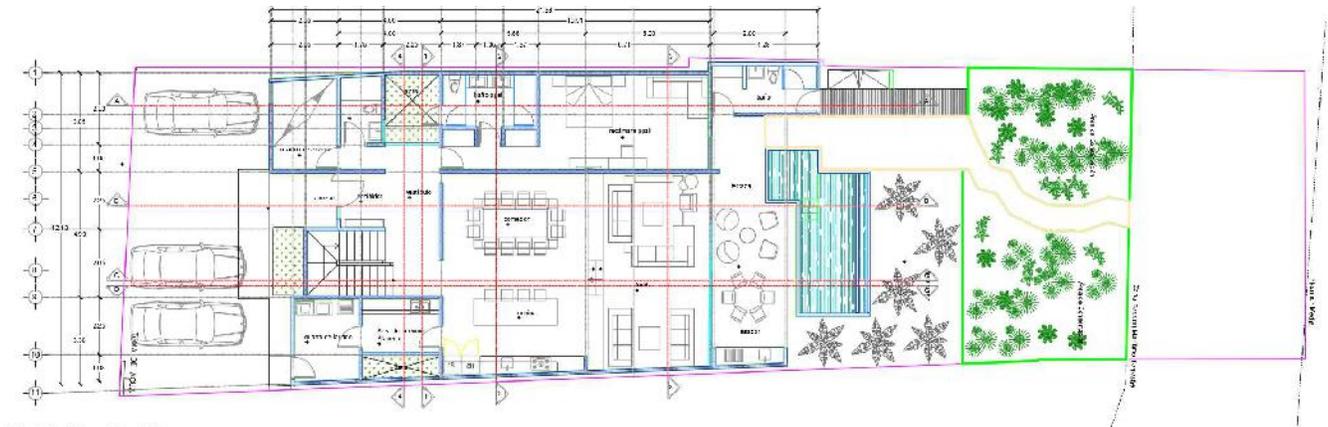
Plano arquitectónico con vista del primer nivel o planta baja
